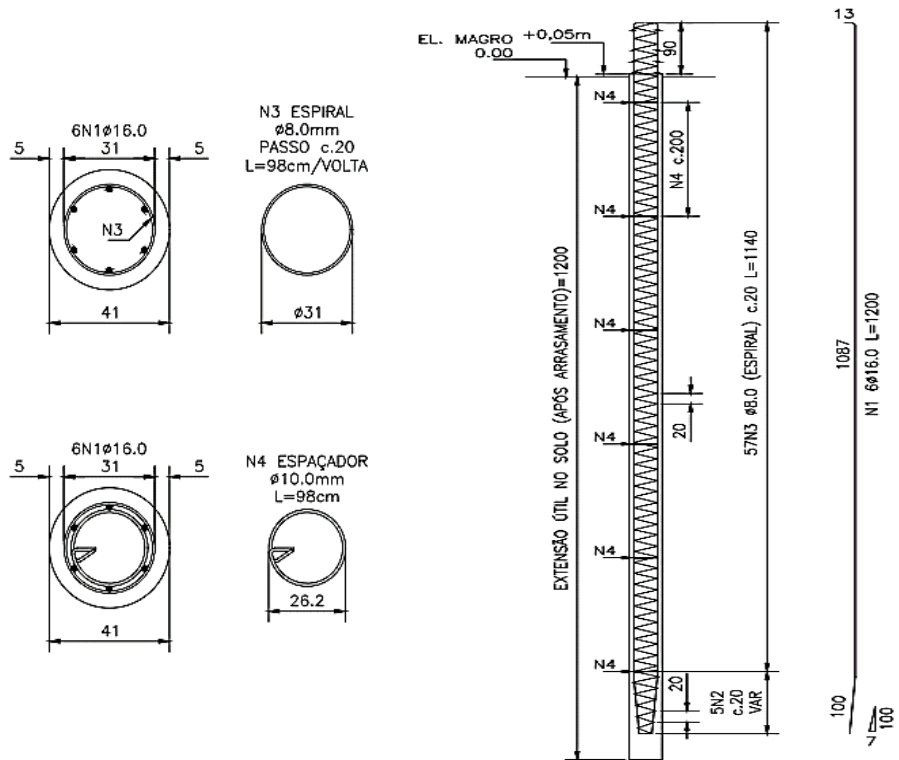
Detalhamento da armadura das estacas tipo raiz 355/410
